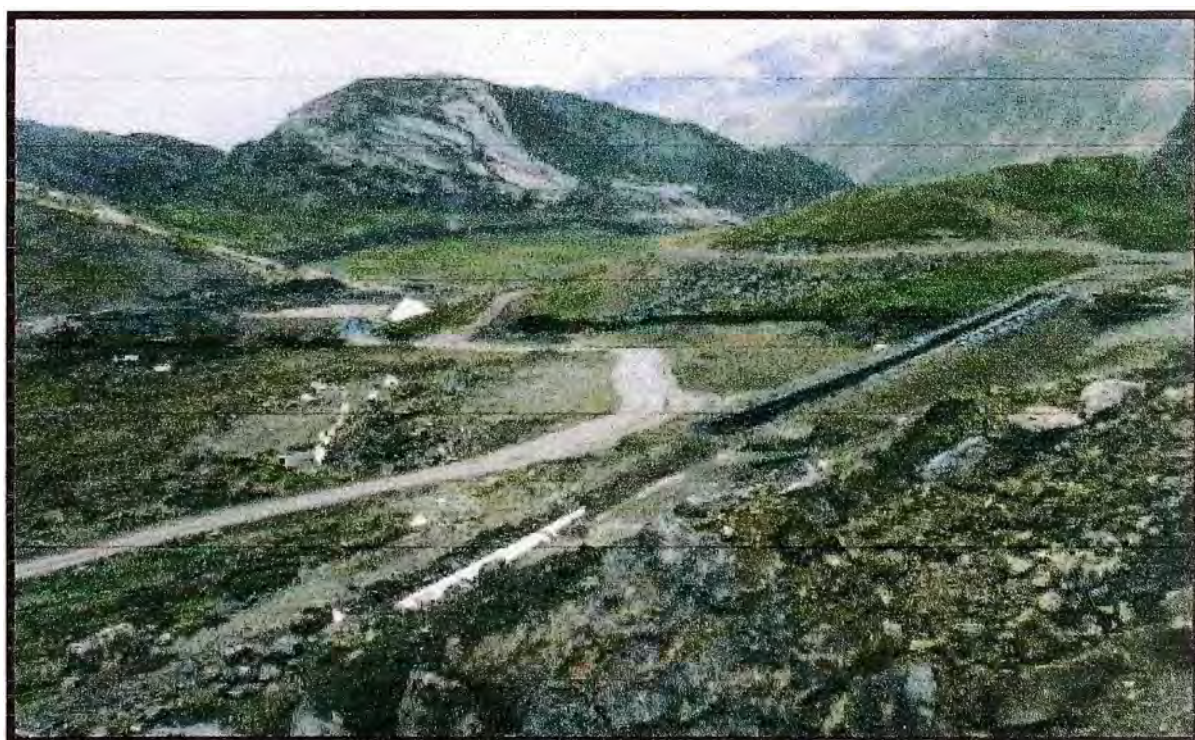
ZONA DE COLAPSO NUEVA PRESA DE RELAVES
